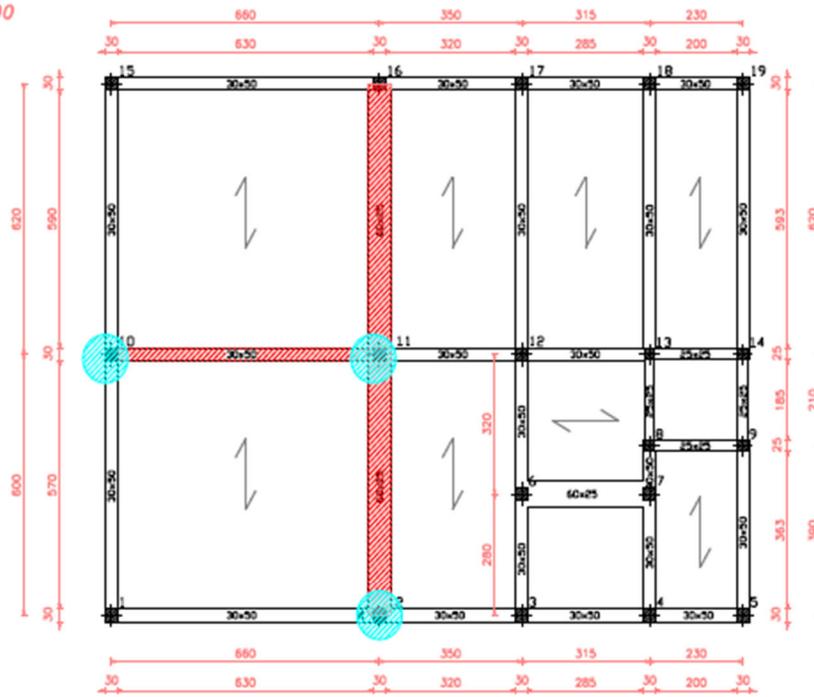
Individuazione delle travi di fondazione strumentate.
